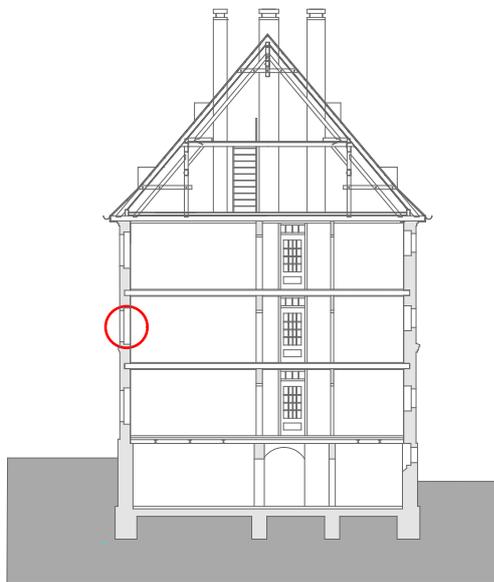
Fensterdetail Bestandssanierung mit Innendämmung
